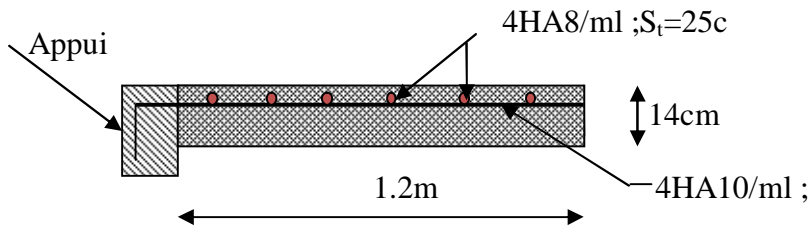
schéma de ferrailage de la dalle (D1, D4)
